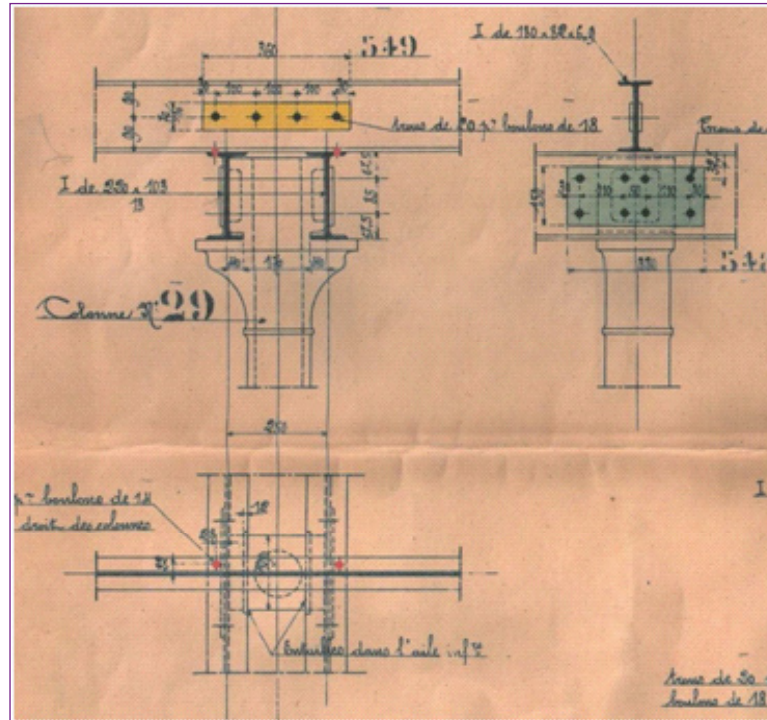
Fig. V. Detalle constructivo de unión de pilar de fundición y viga de hierro doble T
